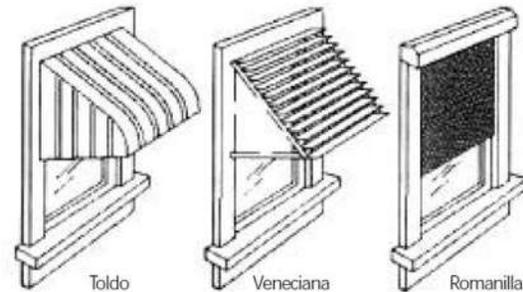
Elementos constructivos para la protección solar. WWW.FAU.UCV.VE.
